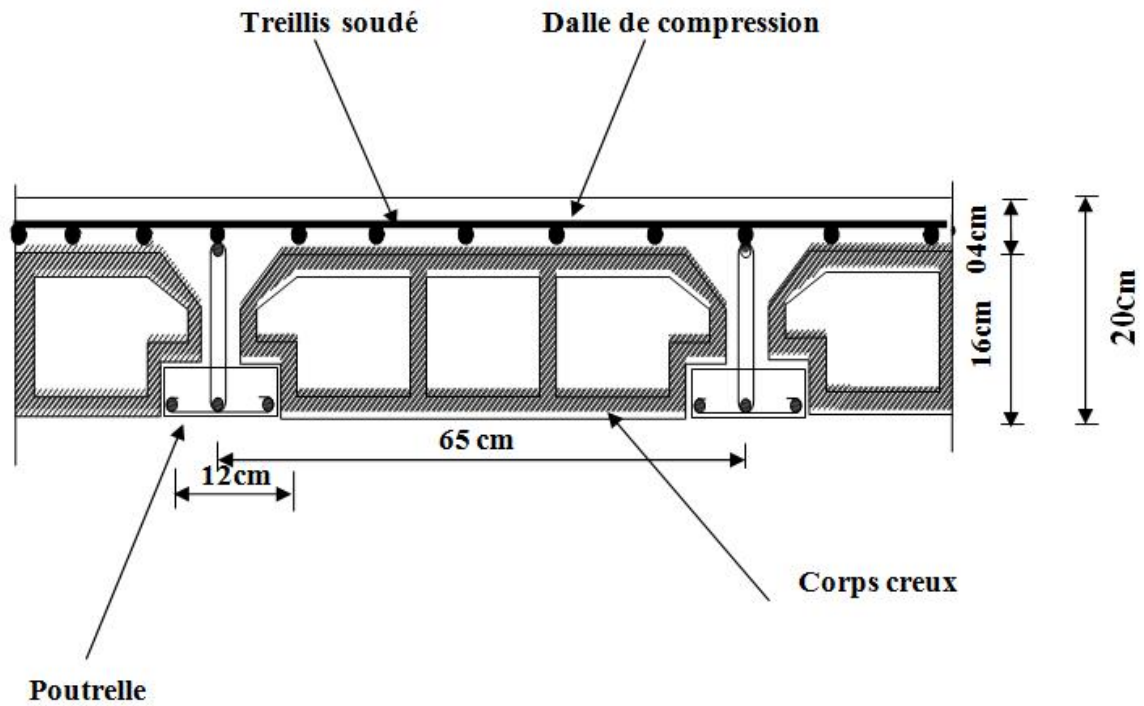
Coupe transversale d'un plancher en corps creux.
